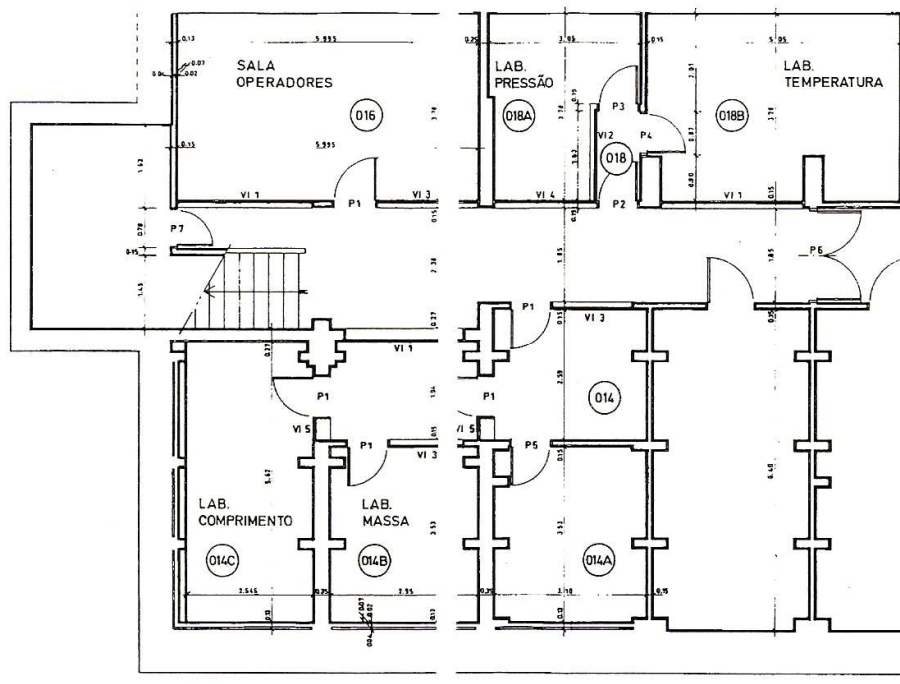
Planta da segunda instalação do LCAM/LNEC
